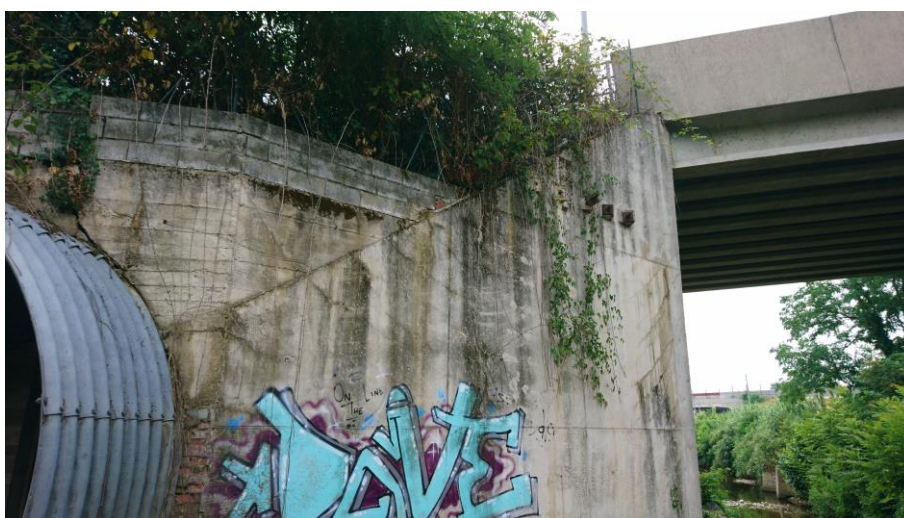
; Spalla e muro andatore Lato Via Camposanto
